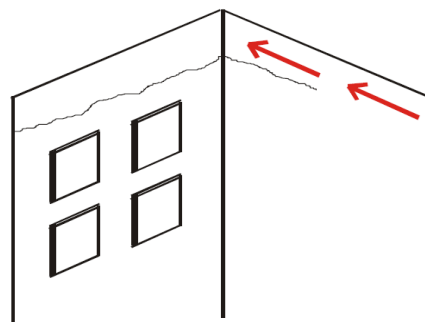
Fissura horizontal na interface entre a laje e a parede por movimentação térmica da laje (DUARTE, 1998)
